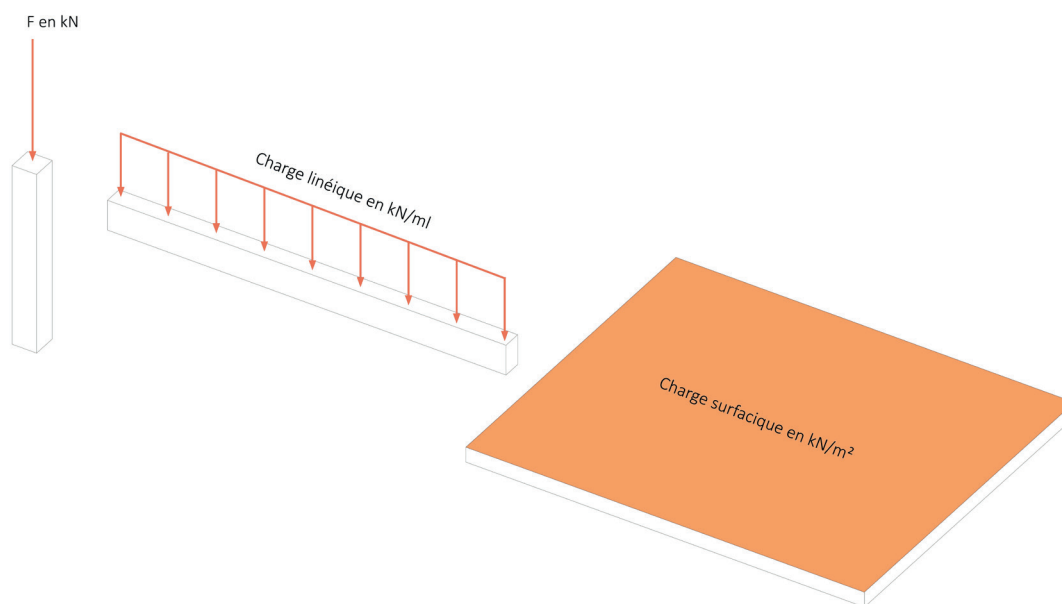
Type de charge structurale selon l'élément porteur : poteau, poutre ou dalle.
